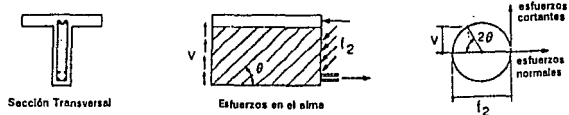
Esfuerzos en el concreto del alma de una viga (Ref. 18)
